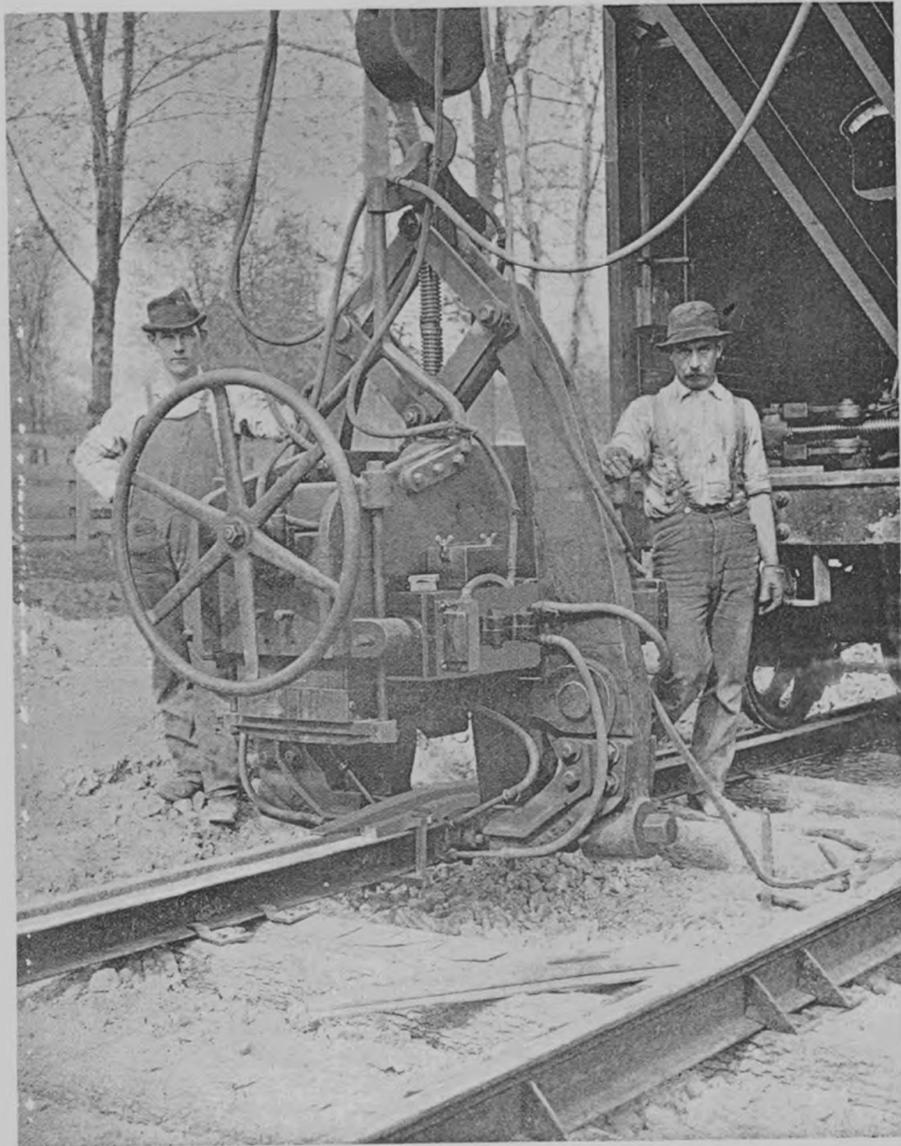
SOUDURE DES RAILS PAR LE PROCÉDÉ THOMS N. PRESSE A SOUDER
